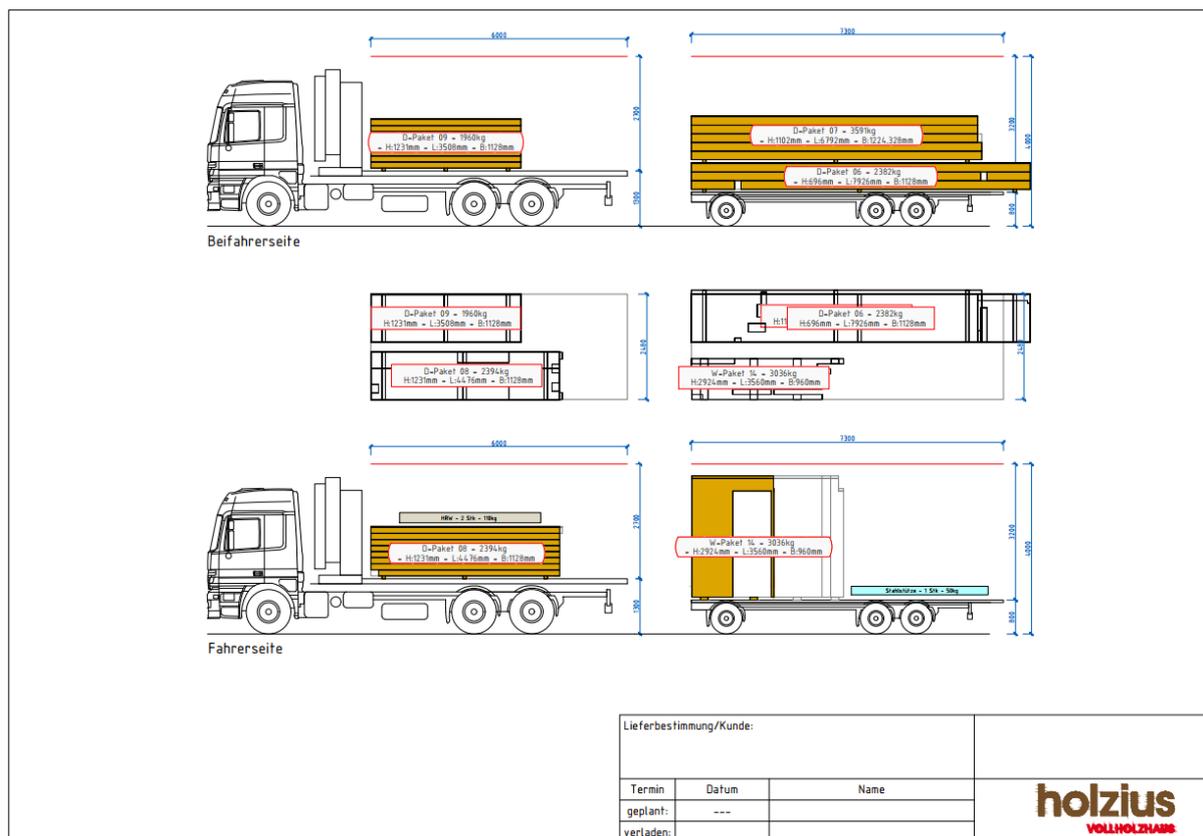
Piano di trasporto per treno rimorchio con elementi di parete e solaio
